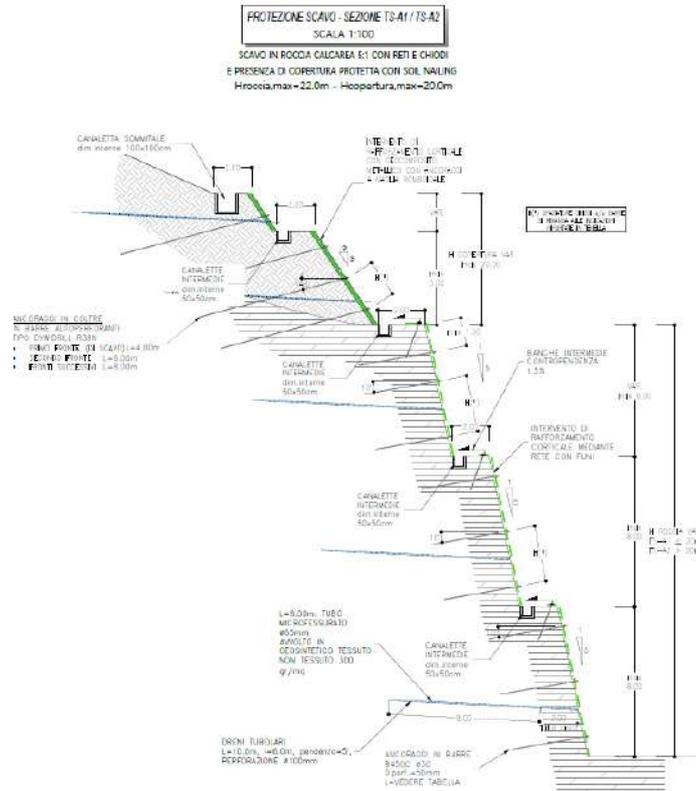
Sezione tipologica trincea e intervento di protezione scavi TS-A1-A2.
